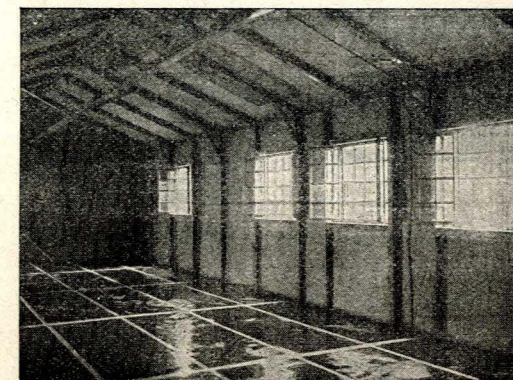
Ossatura della Tenda-baracca con pavimento e telo esterno.
